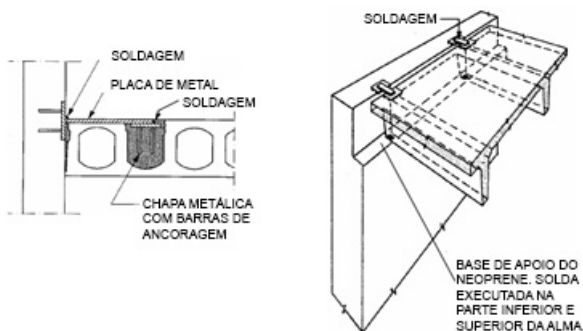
Exemplos de ligações soldadas. Fonte: Unicamp (S.D.).
